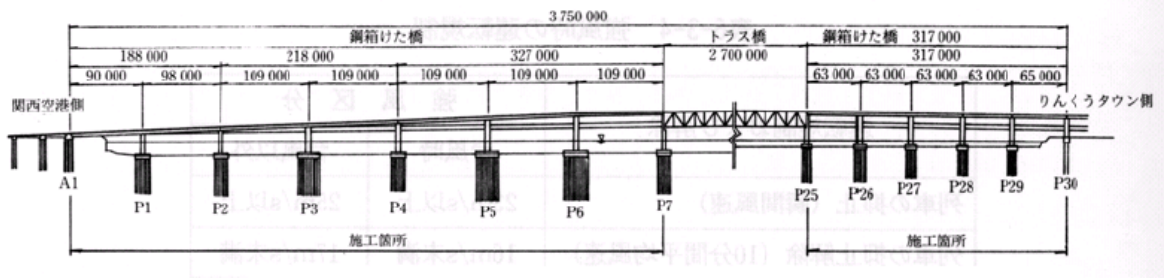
関空連絡橋の工事施工箇所一般図 (単位: mm)
